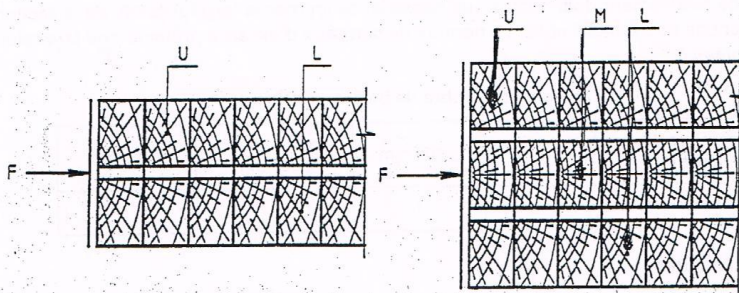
Méthode d'identification proposée, montrant l'emplacement des barreaux d'essais dans la section transversale d'un élément collé horizontalement
